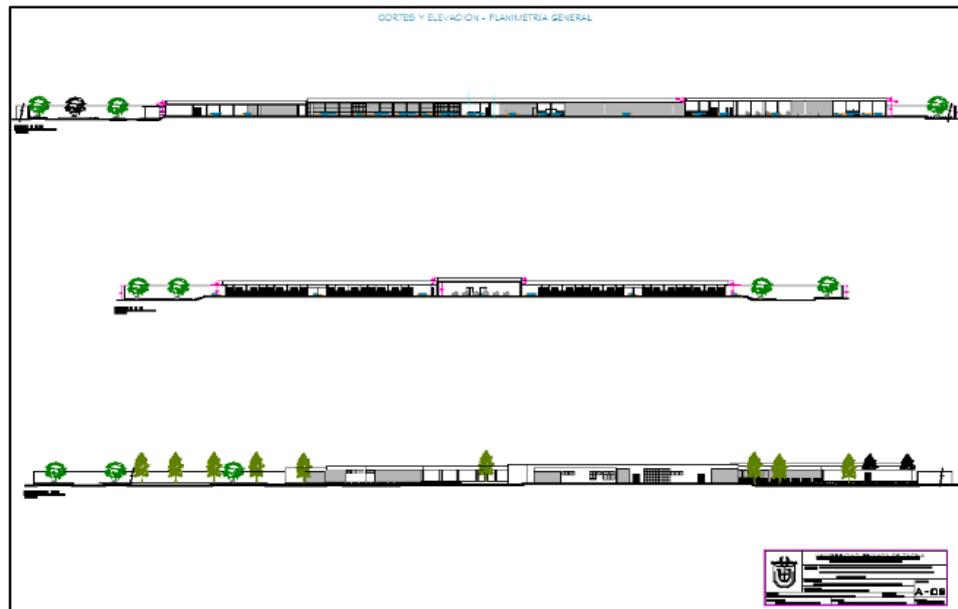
PLANIMETRÍA GENERAL
